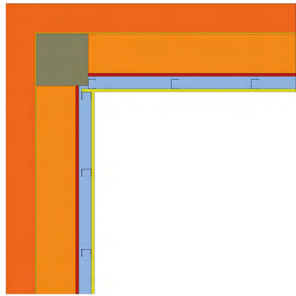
Sistema constructivo de fachada Termoarcilla® Fachada ventilada.
